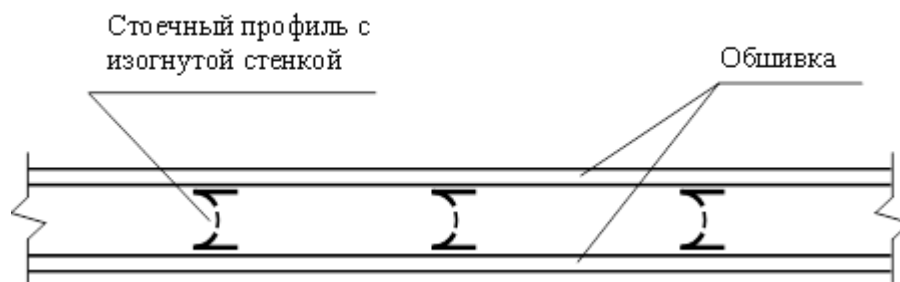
Фрагмент каркасно-обшивной перегородки на стоечных профилях с изогнутой стенкой
